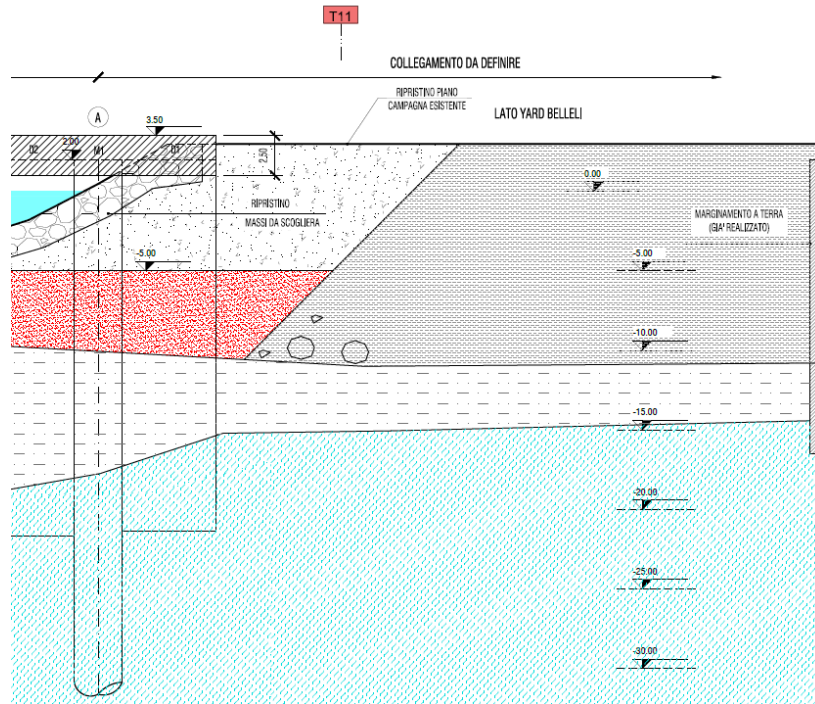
Sezione in asse marginamento di Progetto Esecutivo
